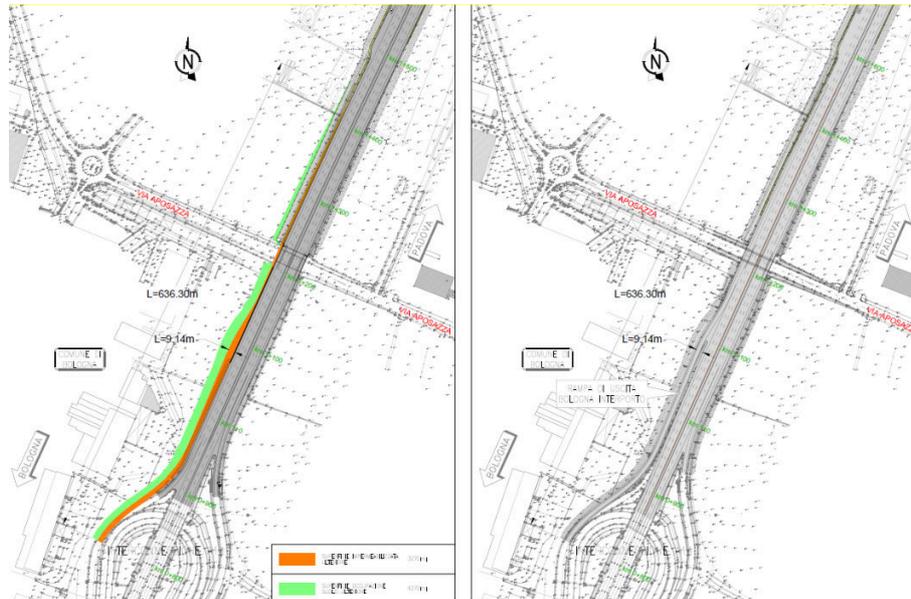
confronto tra progetto in valutazione preliminare (v. planimetria sx) e progetto presentato in Conferenza di Servizi (v. planimetria dx). Fonte: Allegato 1 alla Lista di controllo
